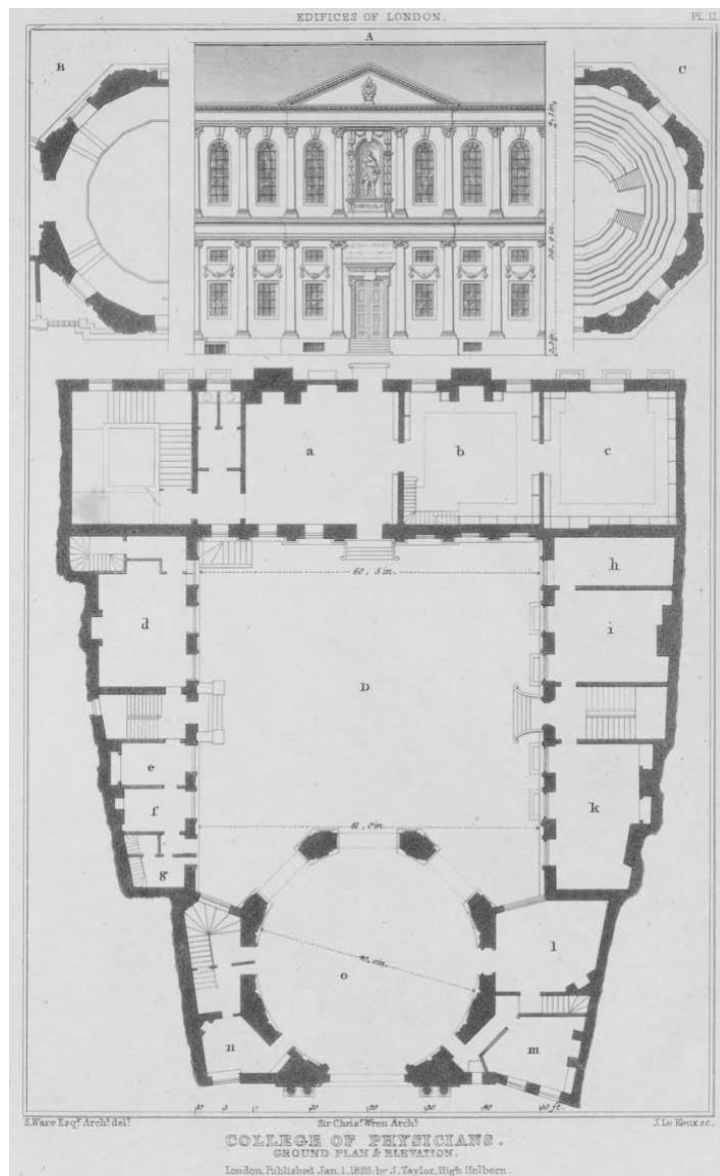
Pianta del collegio con prospetto della casa, Londra, Warwick Lane
